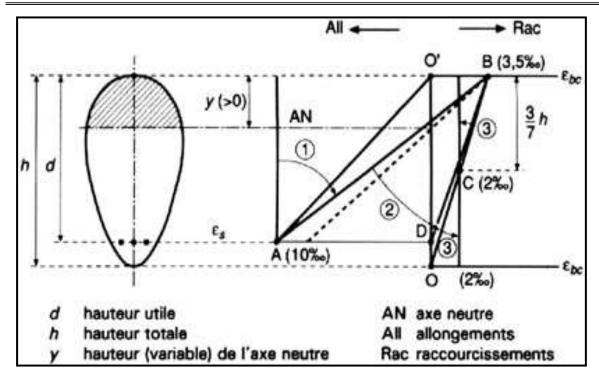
Diagramme des déformations limites de la section règle des trois pivots.
